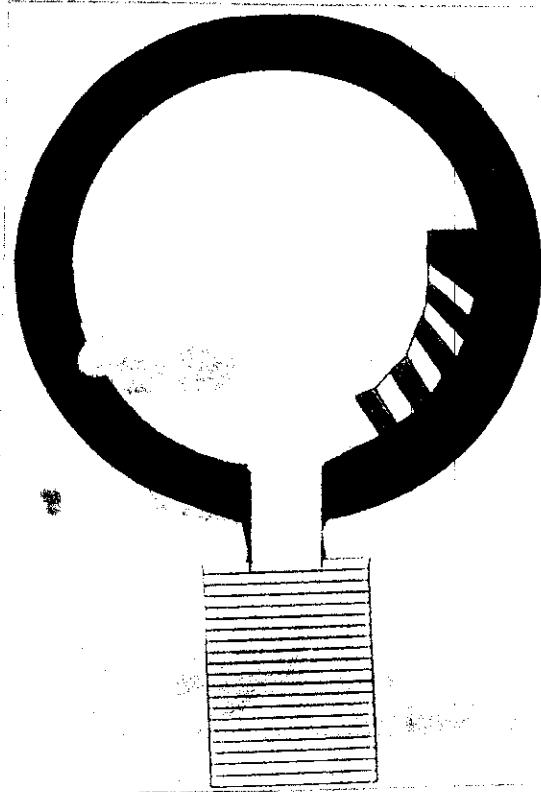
مسقط افقي لطاحونة الرياح بالمنزله
